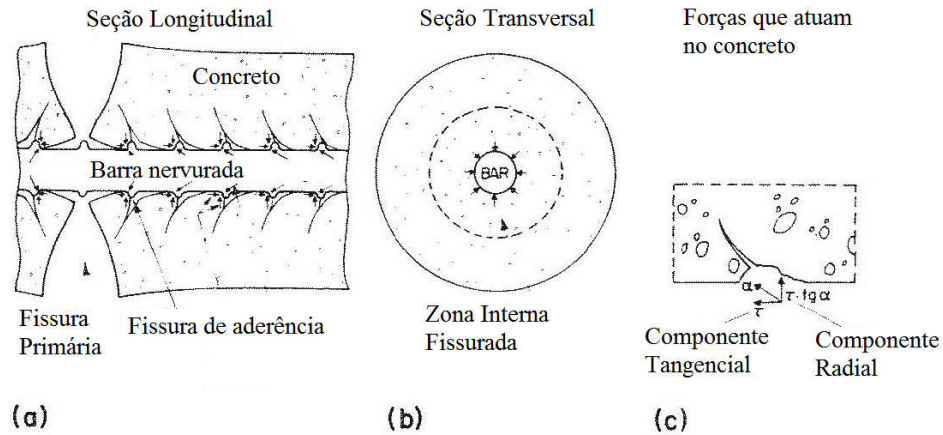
Esquemático das fissuras devido deformação da barra: a) Fissuras internas; b) Fissura radial; c) forças que atuam no concreto (ELIGEHAUSEN *et al.*, 1983).
